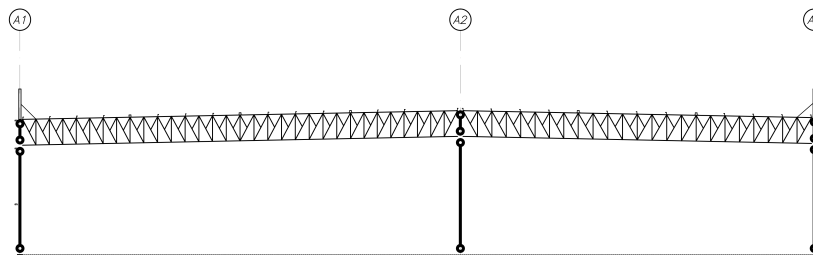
Rótulas plásticas en columnas - Análisis Dirección X
